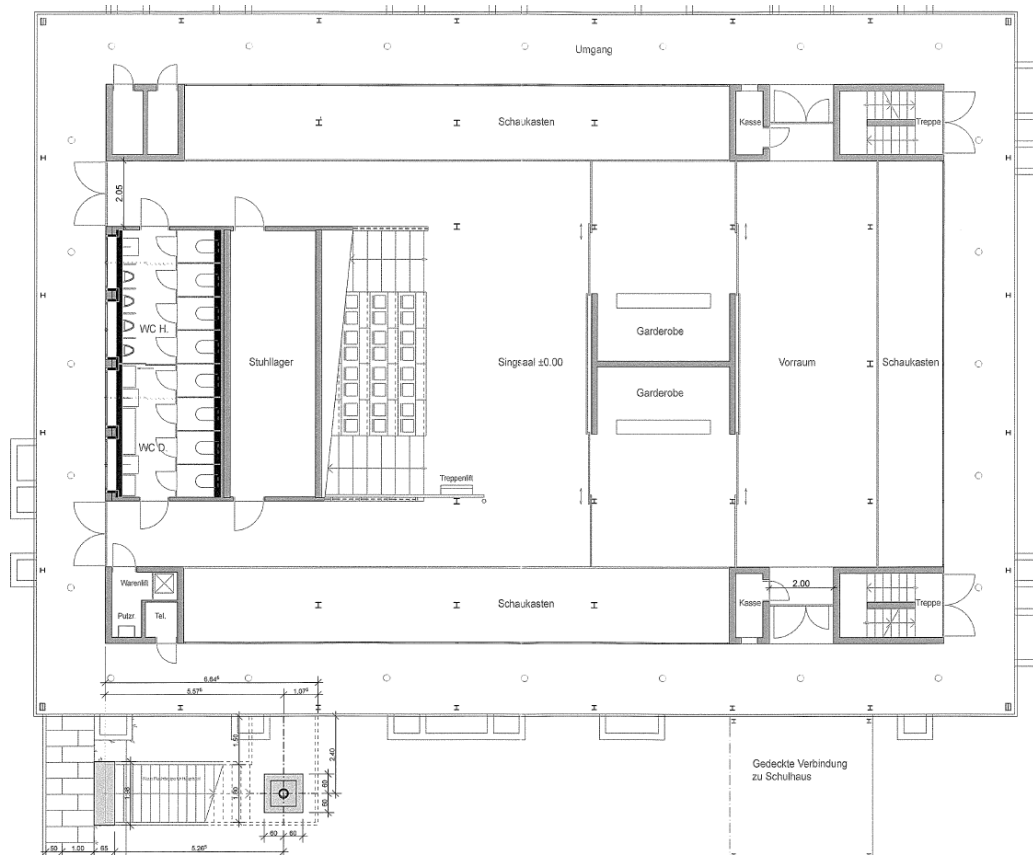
Grundriss Erdgeschoss mit Singsaal
